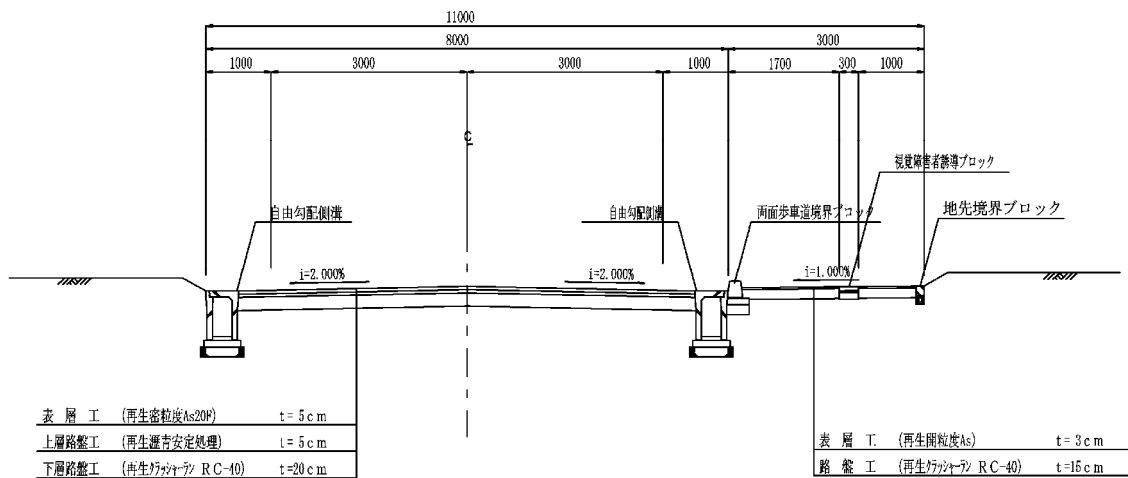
(4) 道路標準断面図(補助幹線道路:11m)
